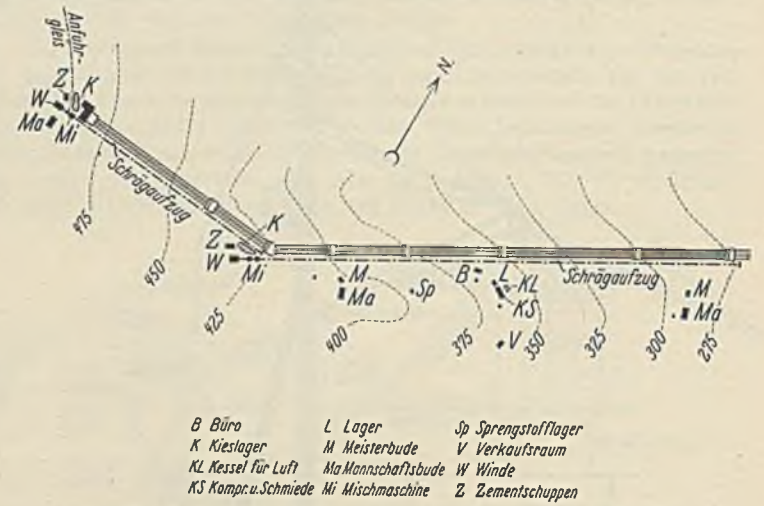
Lageplan der Baustelleneinrichtung der Rohrbahn.
